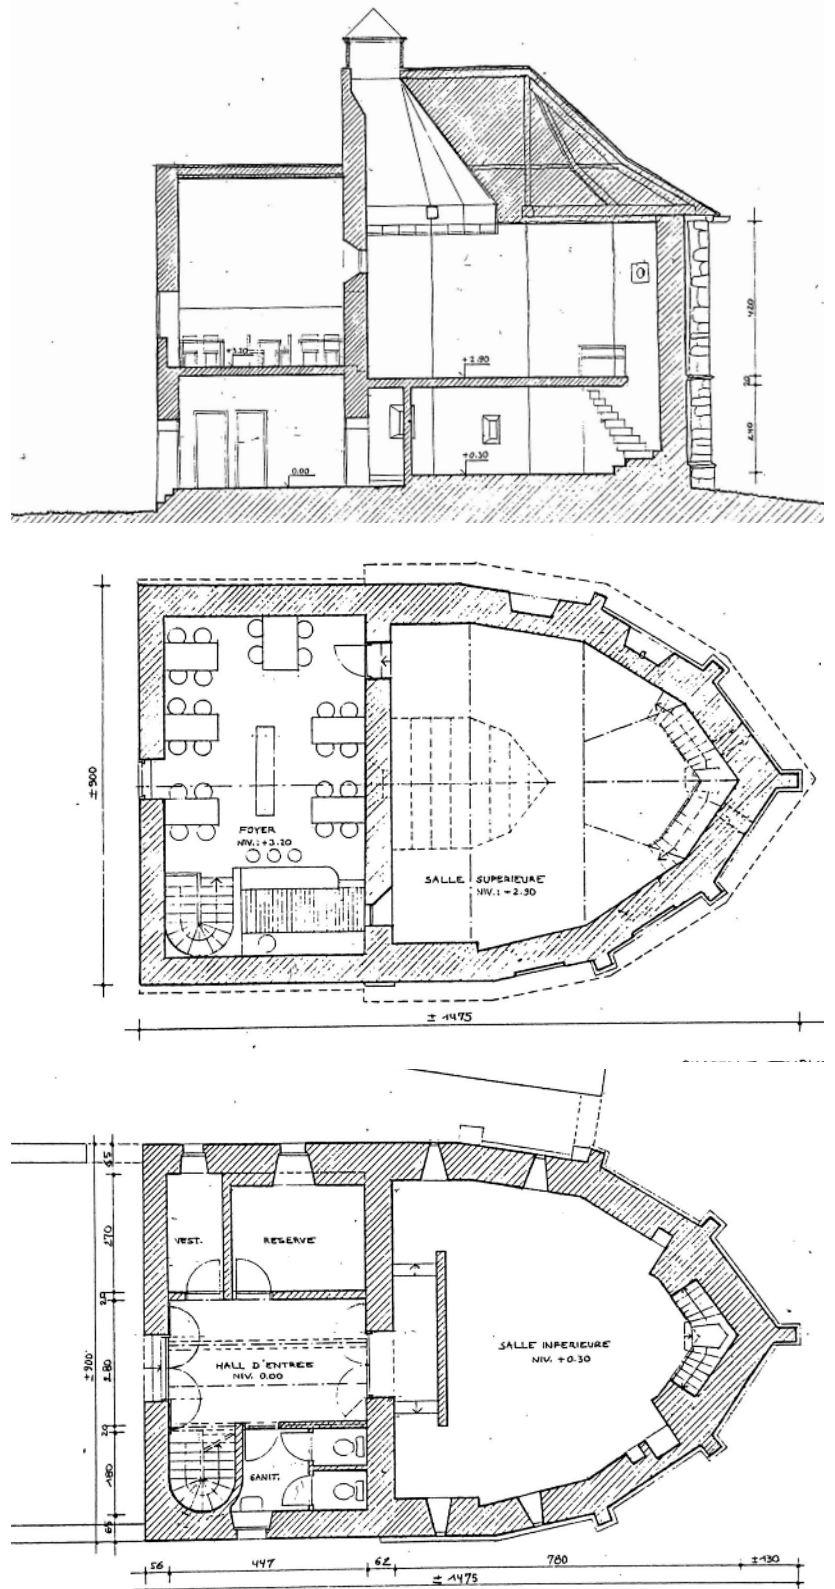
Coupe, plan d'étage et plan du rez-de-chaussée du projet de 1992. Source bureau d'architecture JM DETHIER, 1992.
